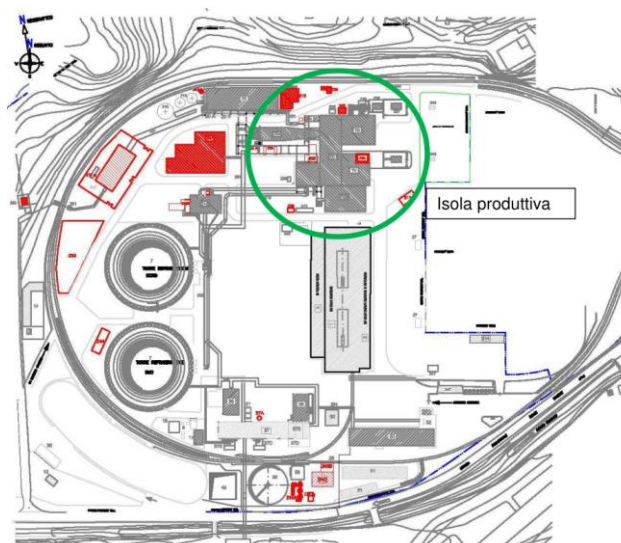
Centrale di S.Barbara – Planimetria di impianto
